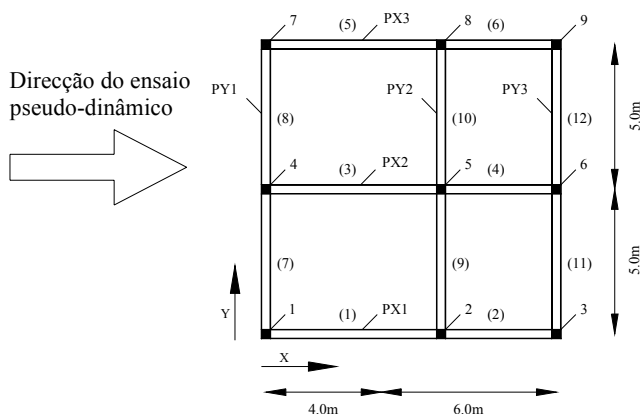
Configuração em planta da estrutura de 4 pisos.
